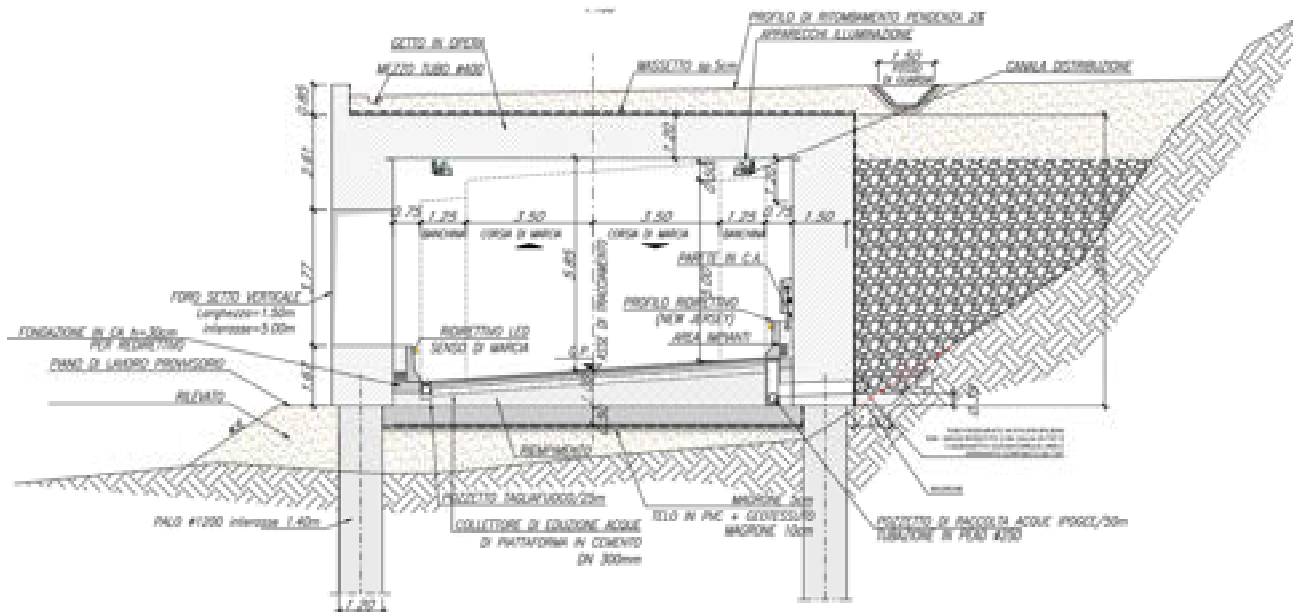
Sezione tipo 4 – Galleria artificiale
